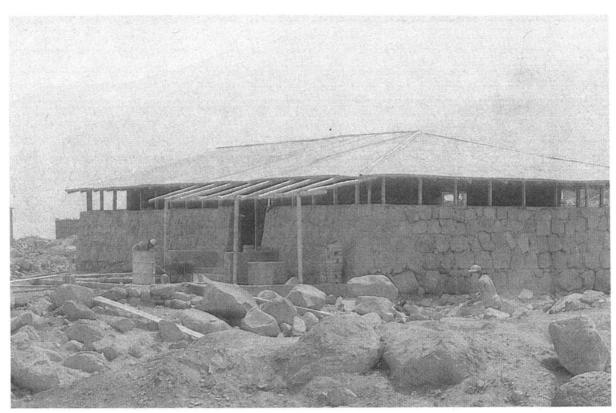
Construcción de la oficina técnica (piedra y bambú) (Cliche X. Ricou).
